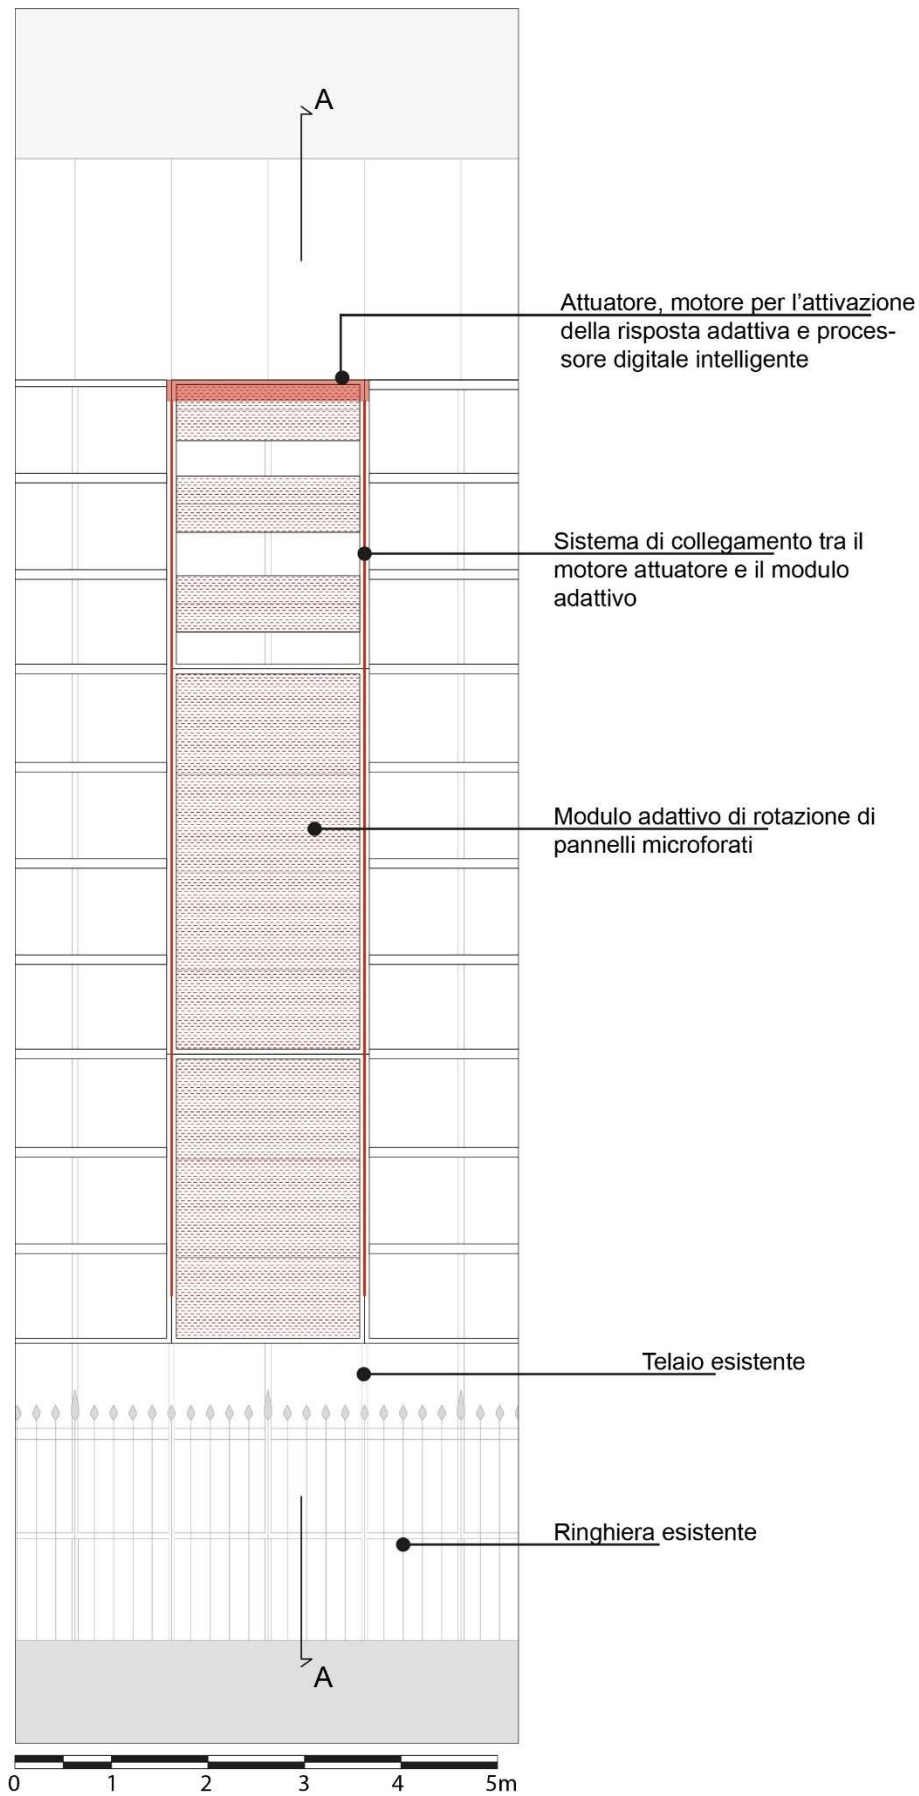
Prospetto della proposta di modulo adattivo sulla facciata sud della "Manica Nuova", scala di dettaglio 1:50. Fonte: elaborazione propria, 2024
